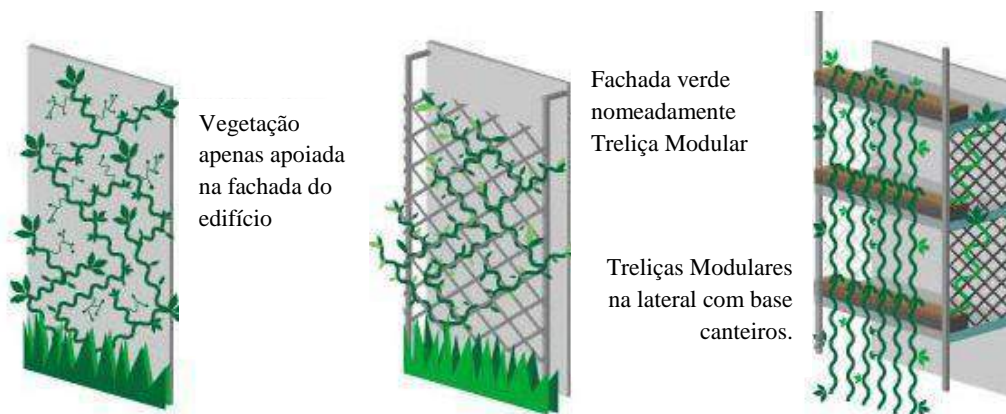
TÉCNICAS APLICADAS ÀS FACHADAS VERDES
